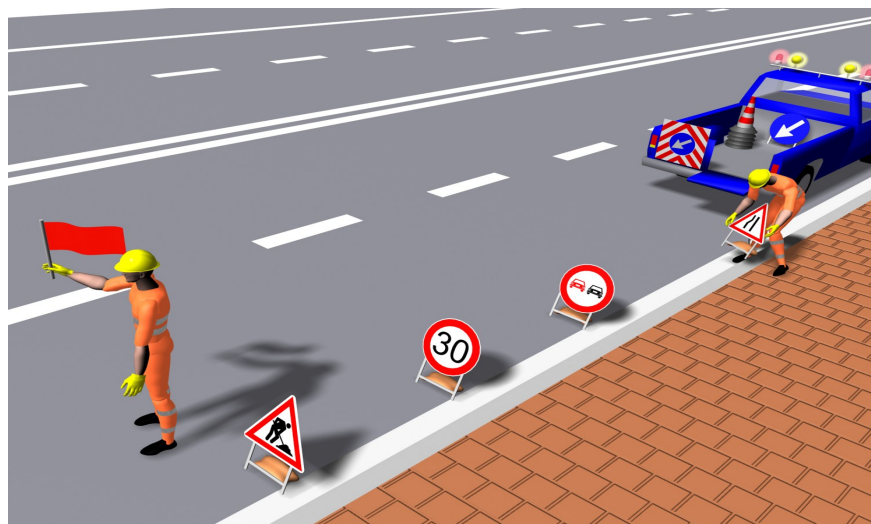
l'addetto alla posa del materiale segnaletico dovrà effettuare la posa stessa avendo cura di tenersi sempre alle spalle il moviere che rallenta il traffico ed avverte l'utenza
